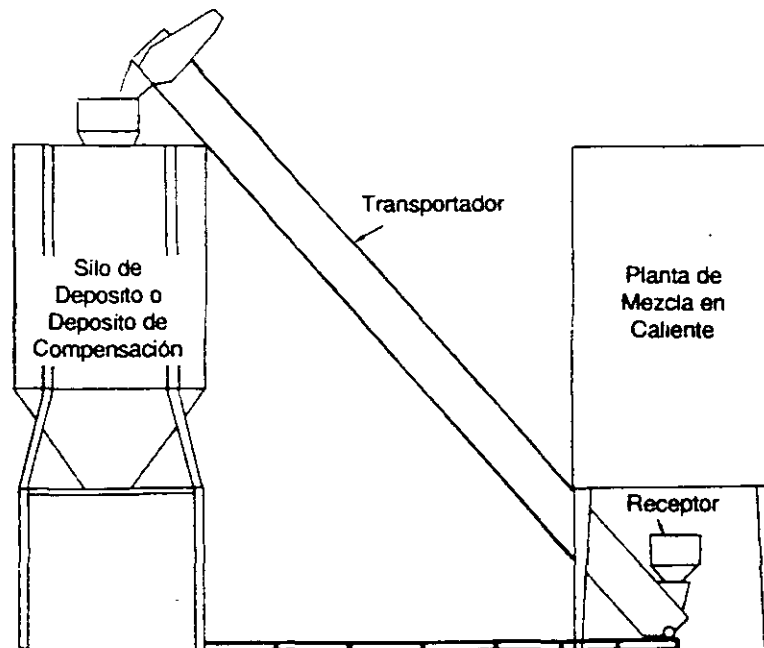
Configuración de una Estructura Típica de Almacenamiento.
